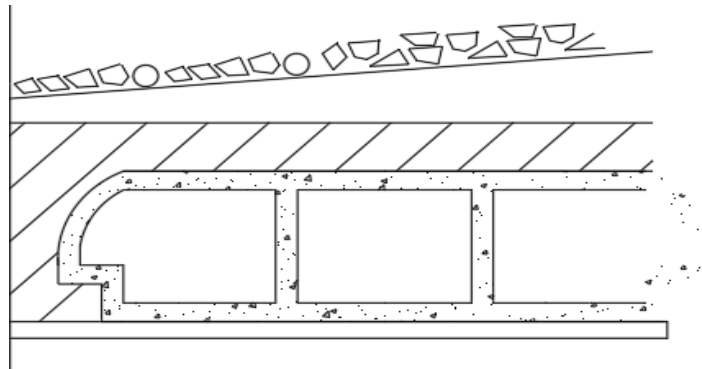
coupe transversale d'un plancher terrasse inaccessible corps creux.
